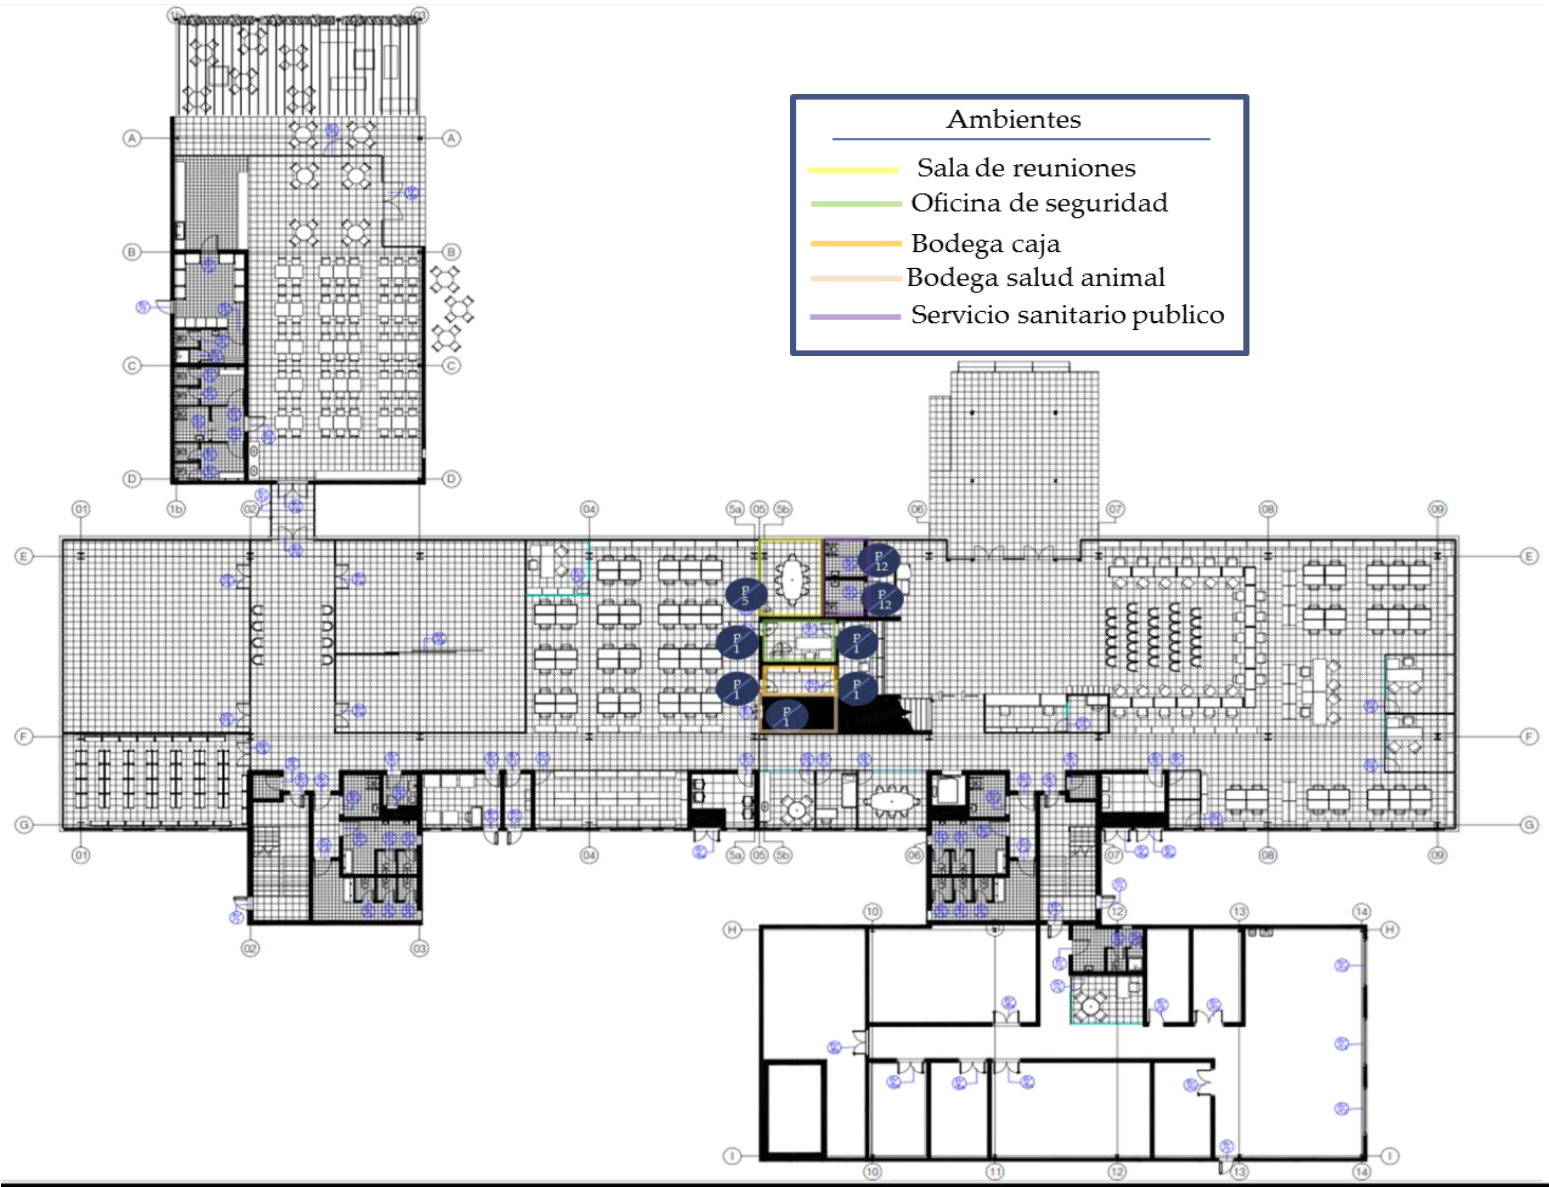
Lamina de planta arquitectónica de puertas modificada
